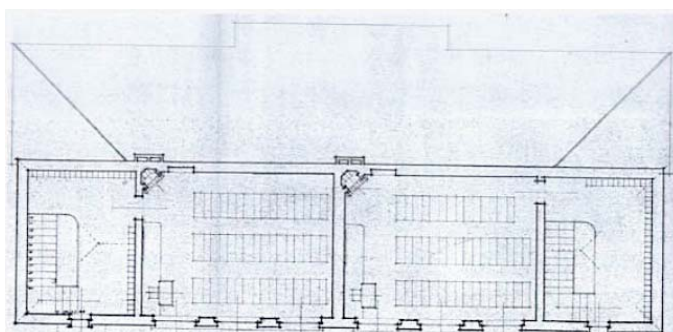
Escola tipo (dois pisos), Plano dos Centenários, planta do piso superior
